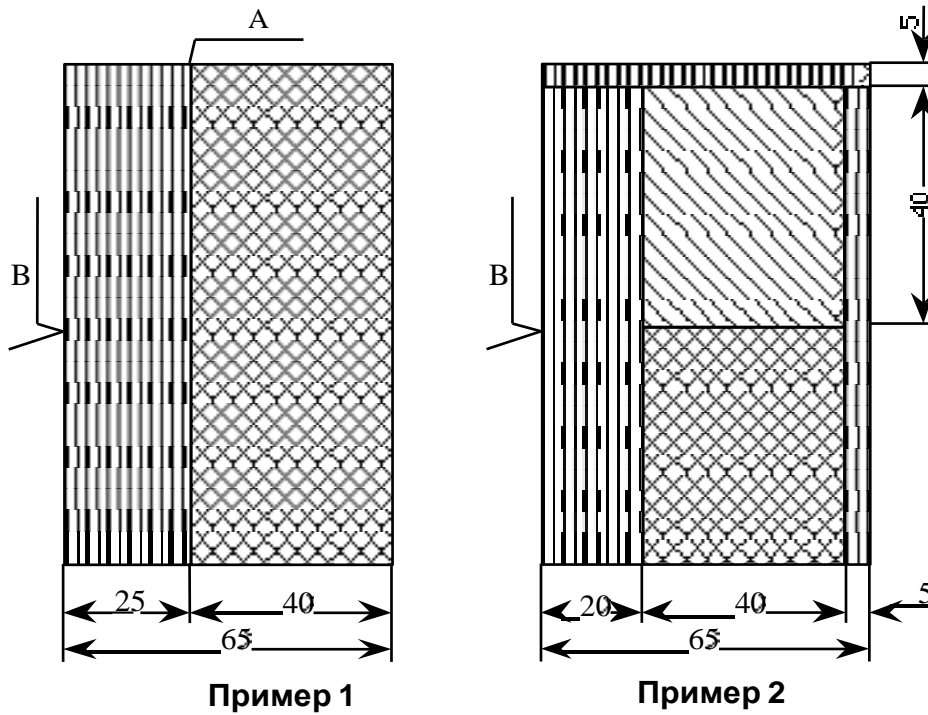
Вид испытательного угла с основными конструкциями боковых стен и основания
